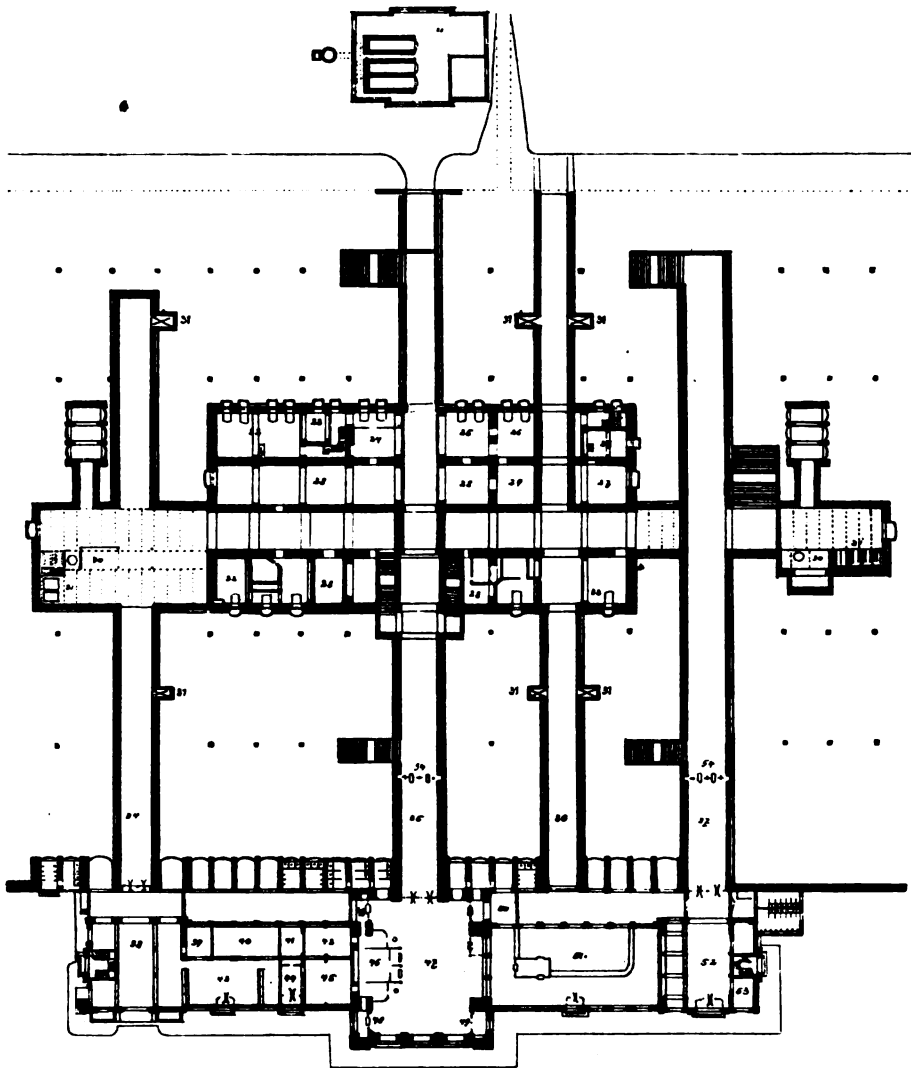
Hauptbahnhof. Grundriss des Vorplatzgebäudes. 1:1280.
